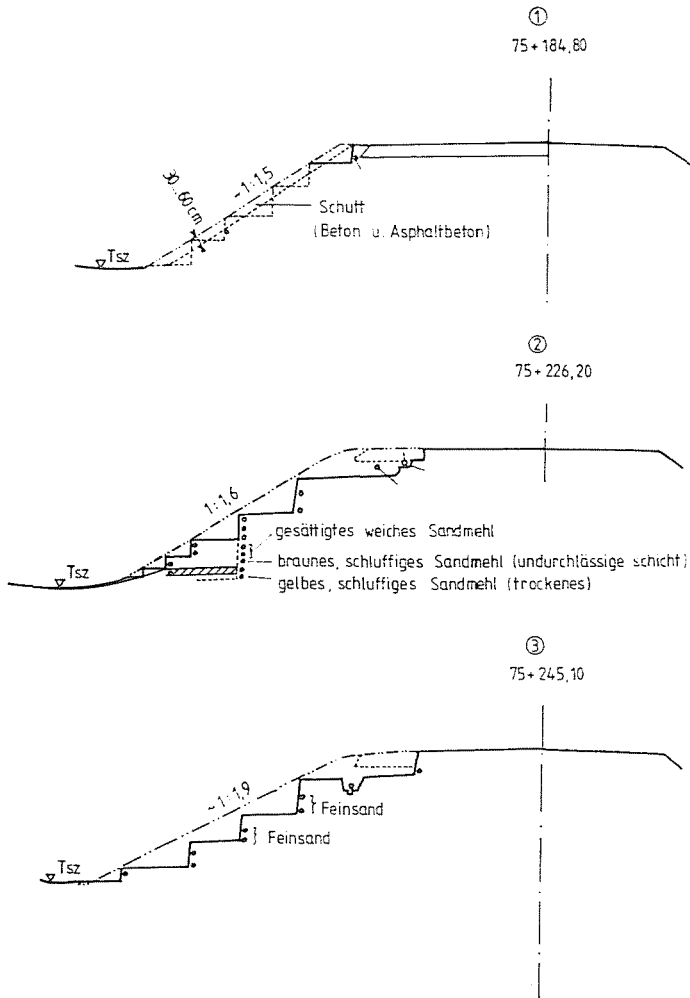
Die Querschnittsprofile der Aufschlüsse
